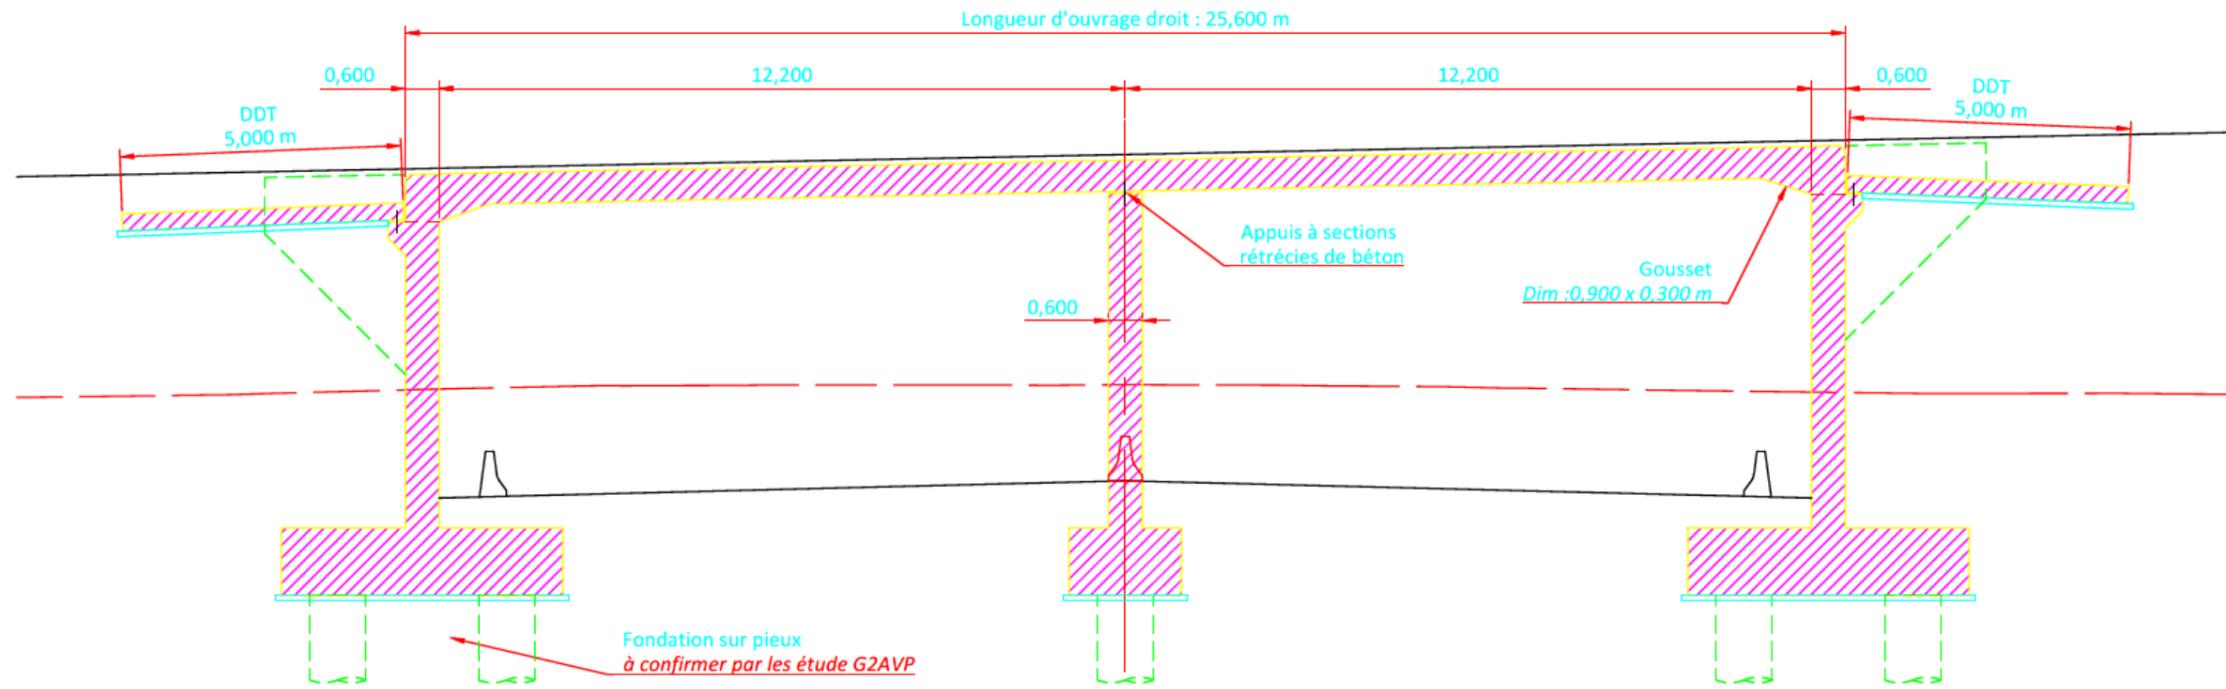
PS4 et PS4bis – Coupe longitudinale de l'ouvrage projeté
